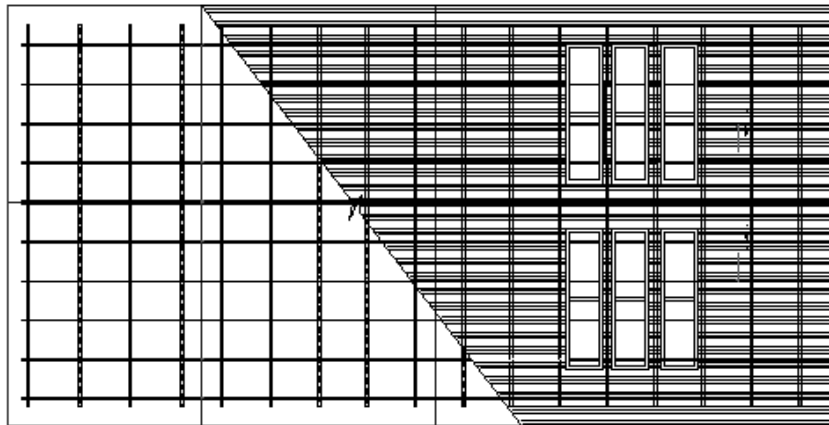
Composición estructural de la cobertura - planta. Fuente: propia.
